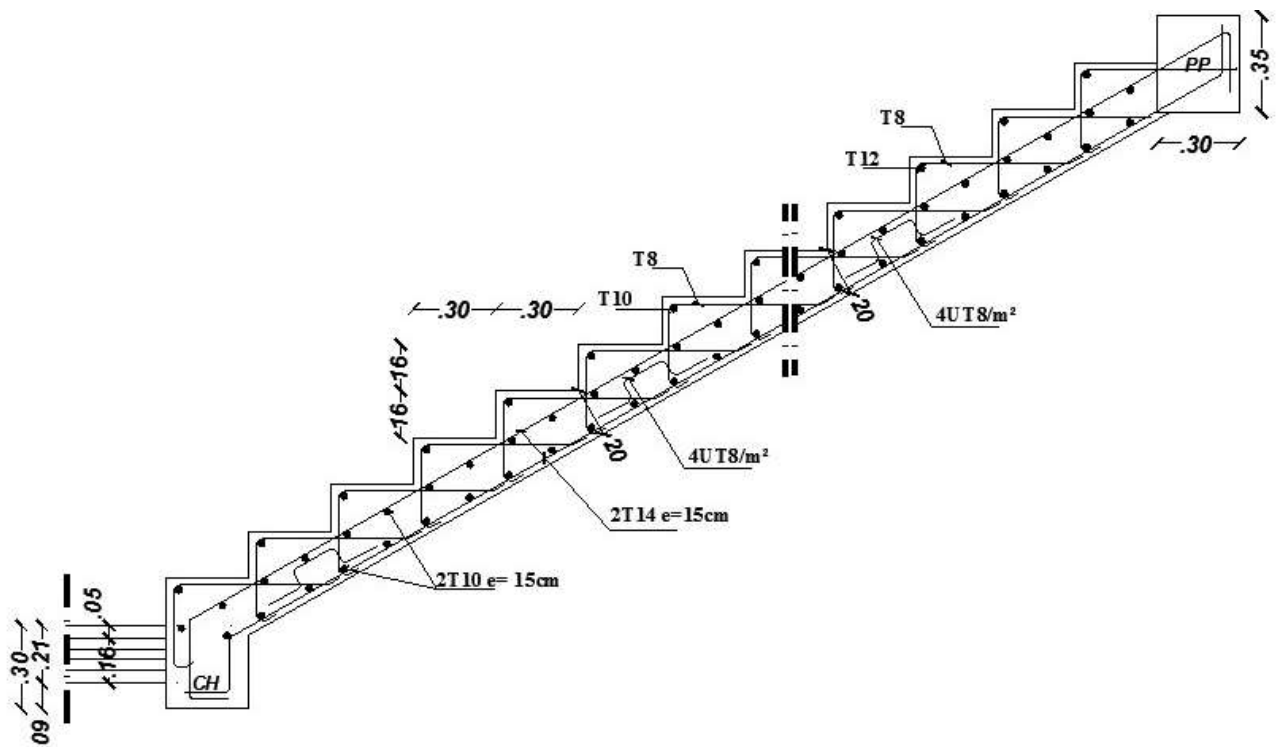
Coffrage et ferrailage de l'escalier type 2
